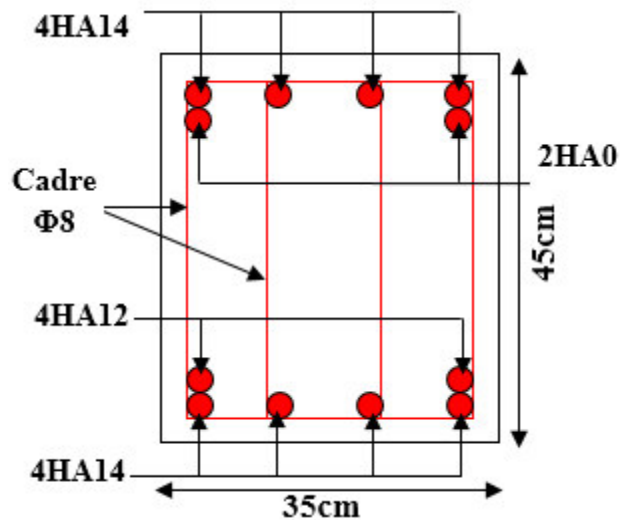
Schéma de ferrailage de la poutre brisée.
